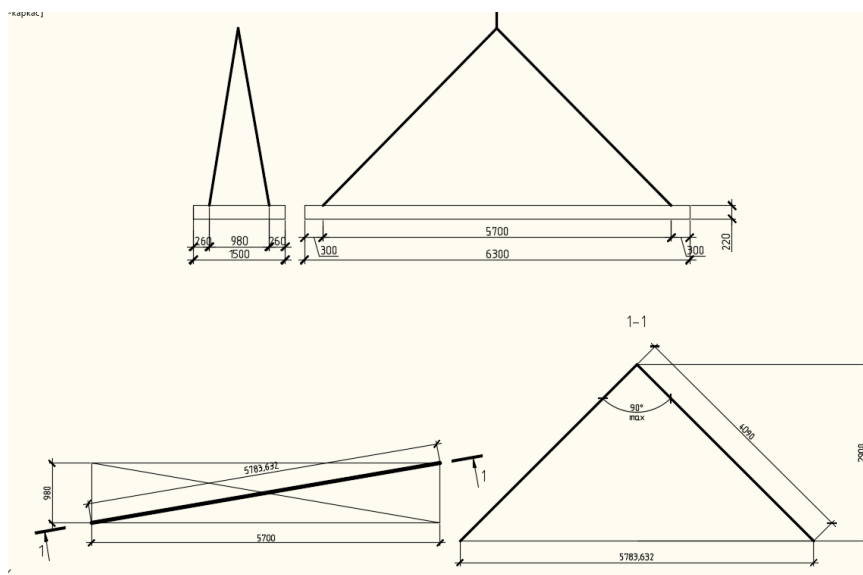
Определение длины стропла для монтажа наиболее тяжелой плиты перекрытия
